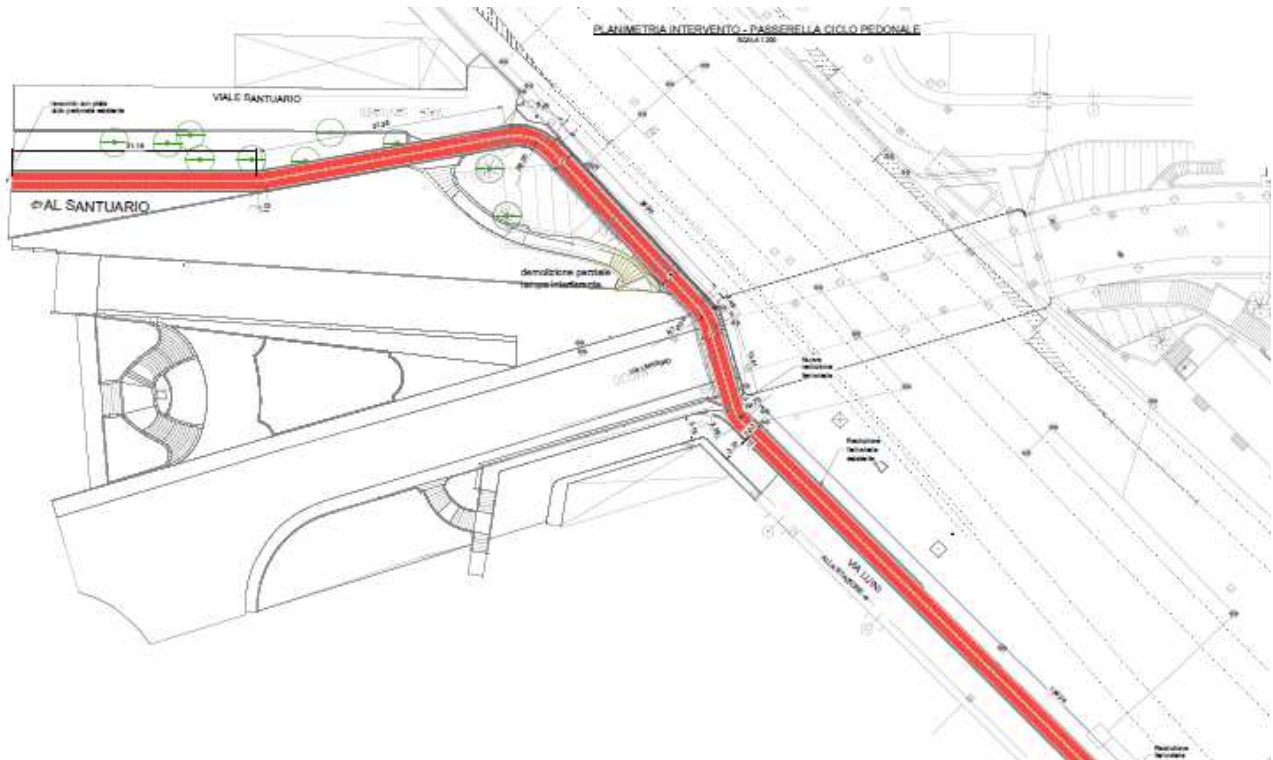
Tracciato planimetrico nuova pista ciclo-pedonale su via Luini
